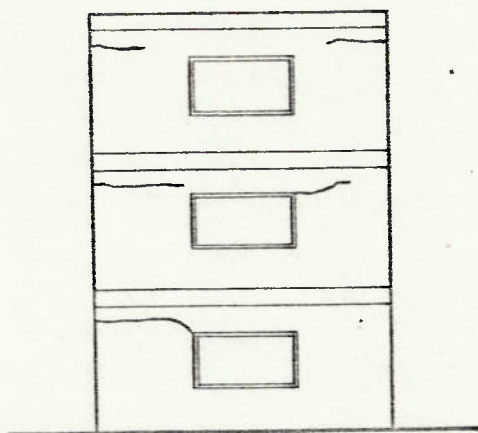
Fissuras em parede externa, causadas pela retração de lajes intermediárias
